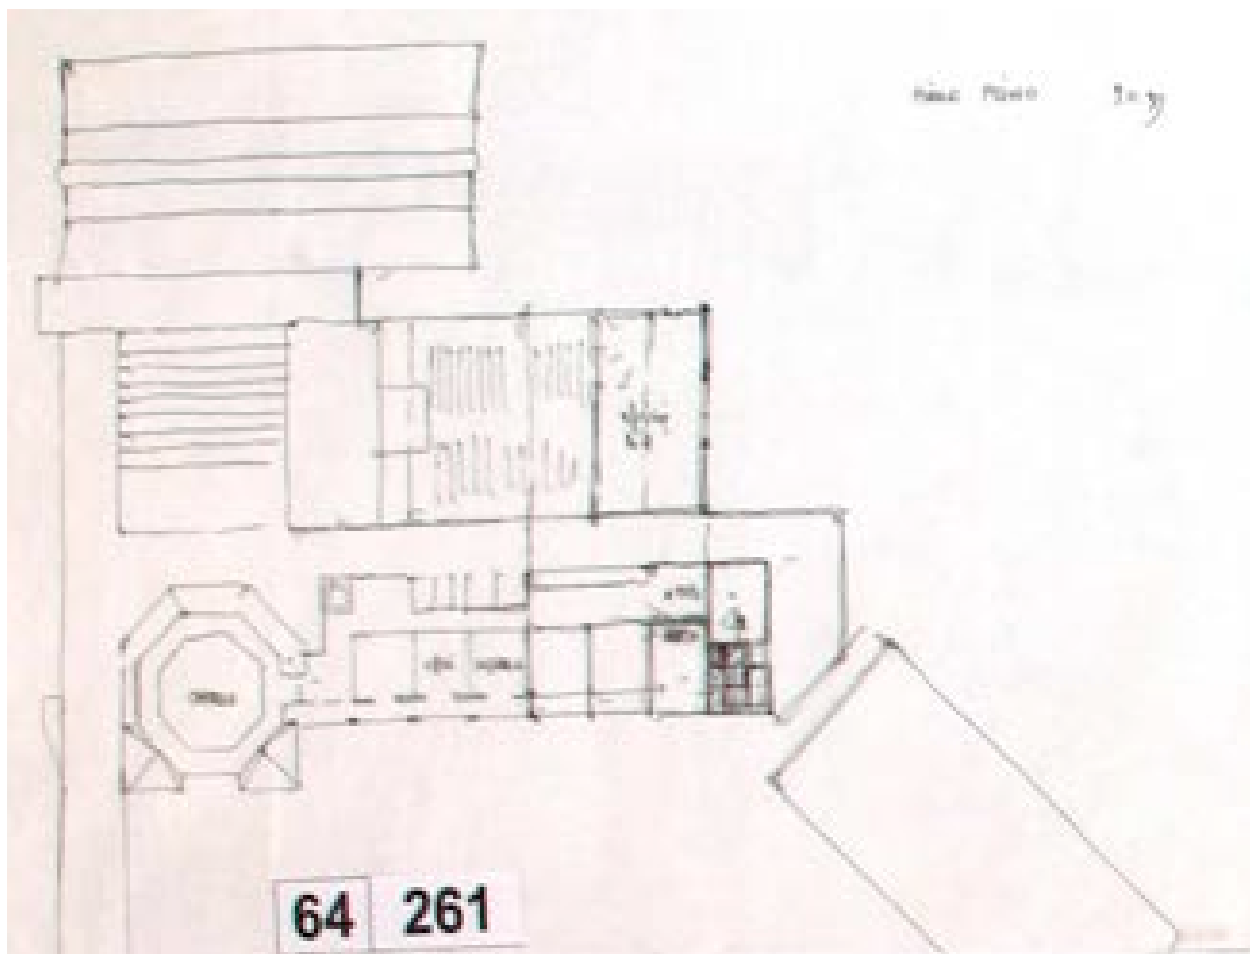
Pianta piano primo, stato futuro – 09/11/1993 (AABS-64_261)
